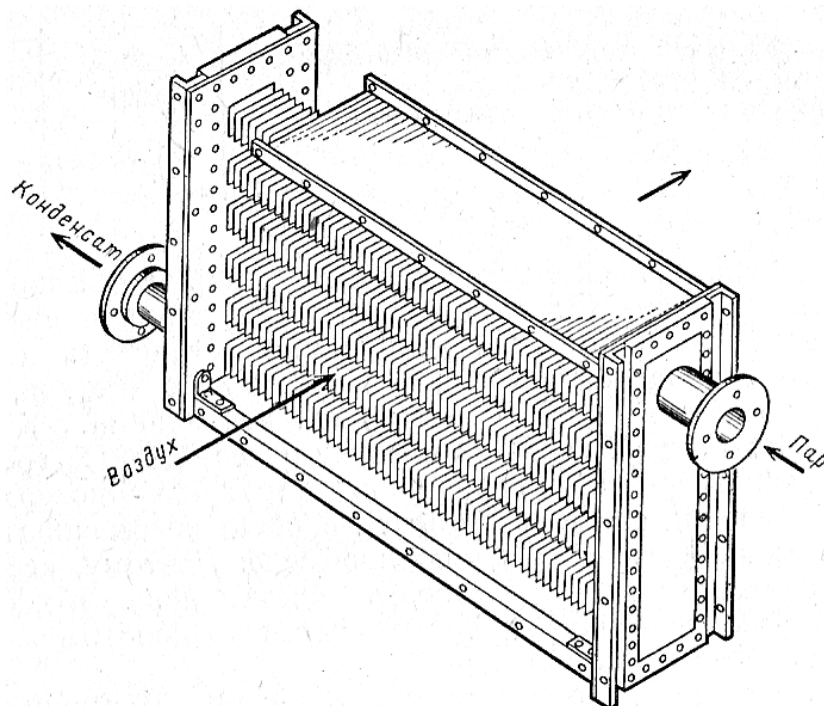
Пластинчатый калорифер для нагрева воздуха
